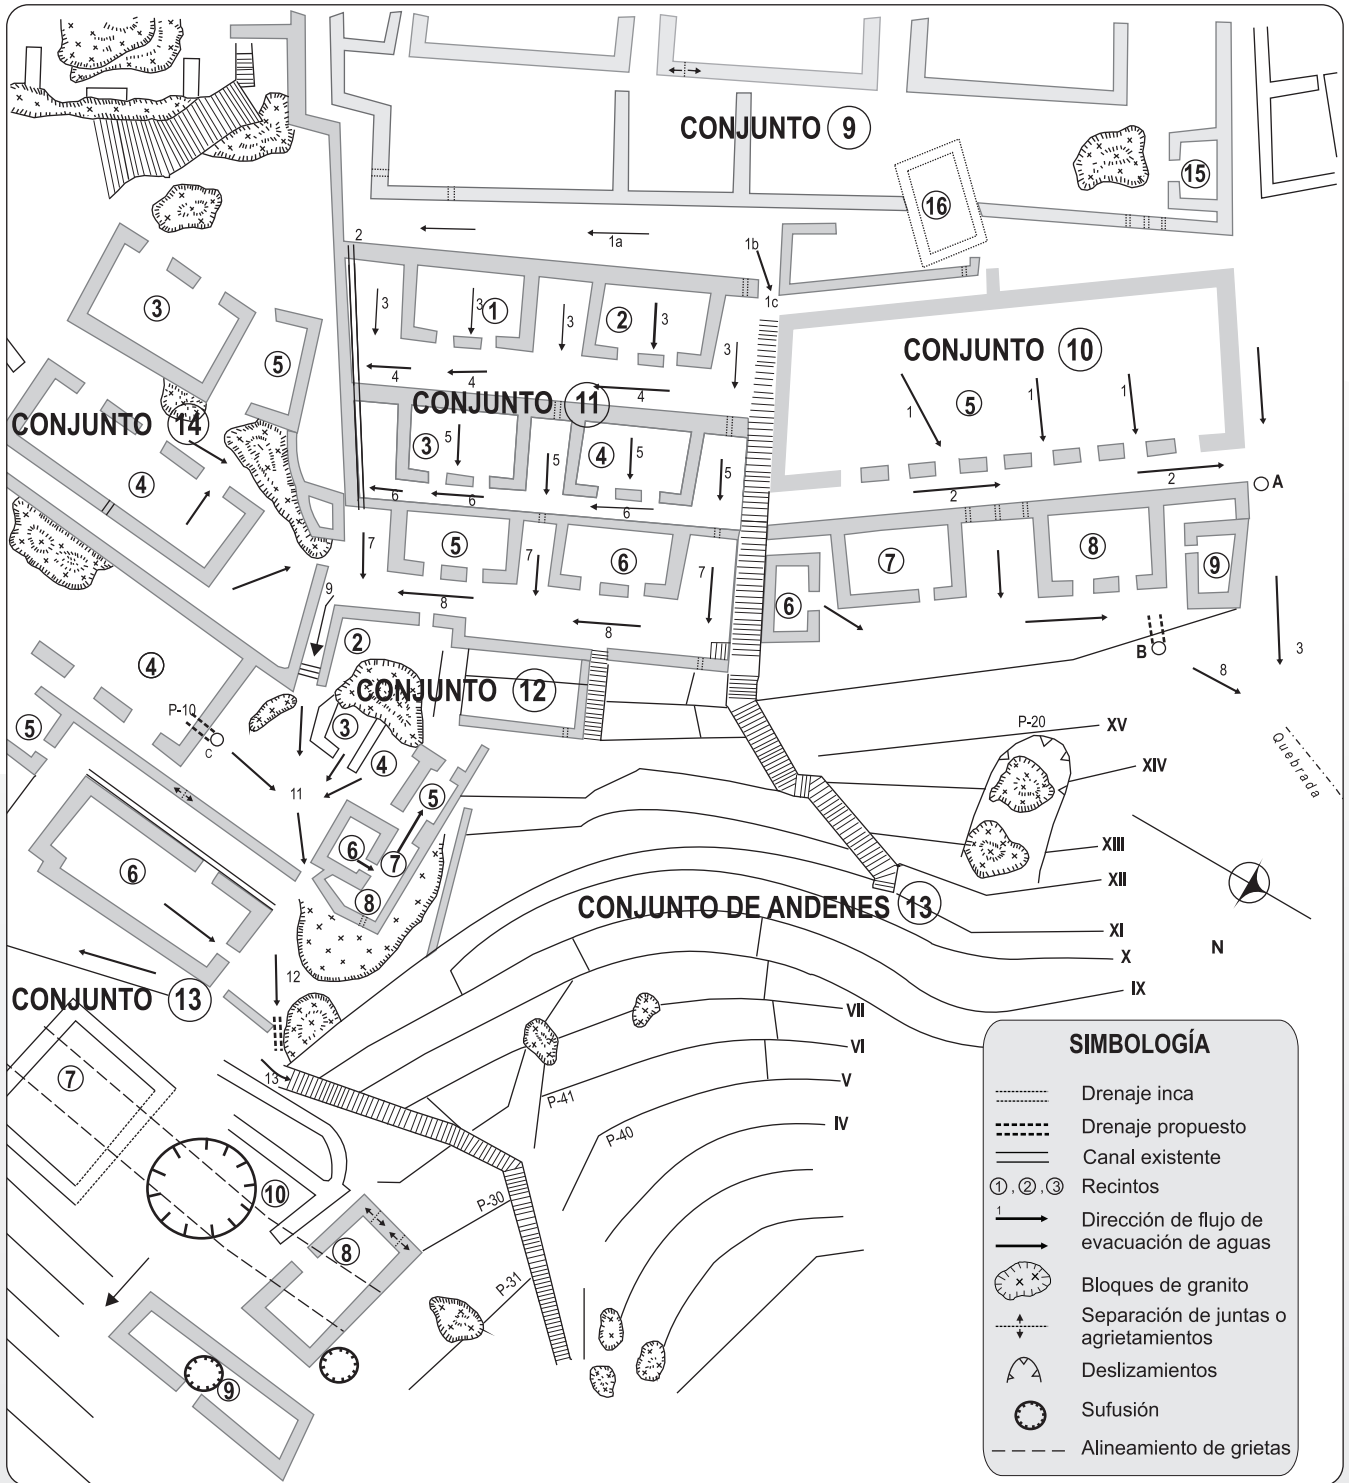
Propuesta de drenajes para los Conjuntos 10, 11, 12, 13, 14 y el Conjunto de Andenes 13. Tomado y modificado de Carlotto et al. (1994c).
